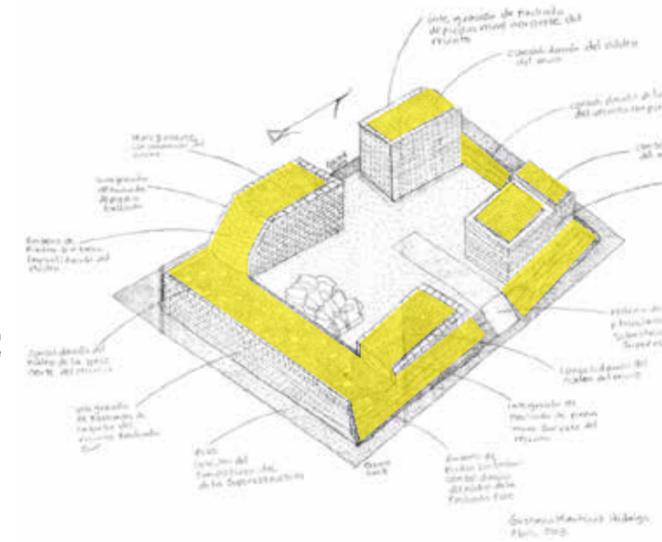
Dibujo Edificio 1, Cámara superior, reconstrucción del proceso de restauración. Detalle de reconstrucción. Consolidación de núcleo, basamento y muros del recinto de la cámara. Resane interior de la cámara. Dibujo: GAMH 2002
